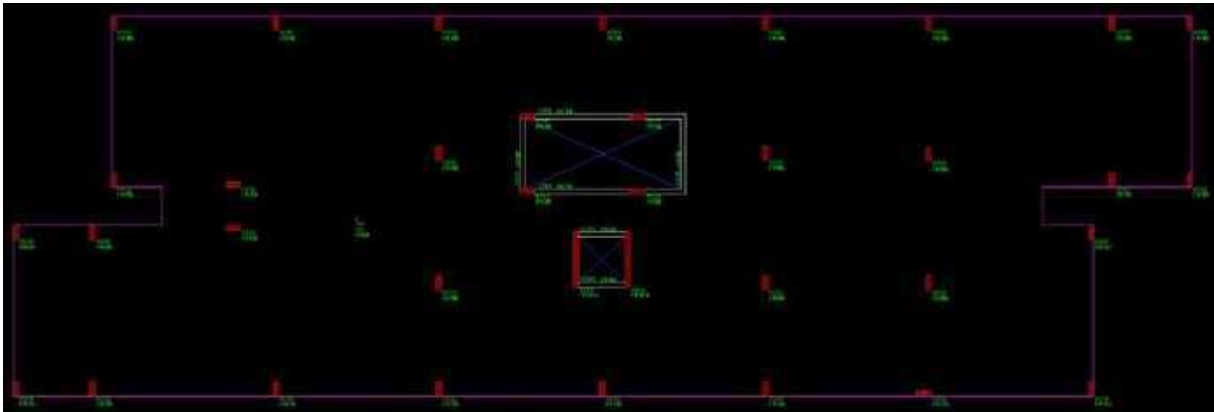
Forma em Estrutura Reticulada de Concreto Armado
